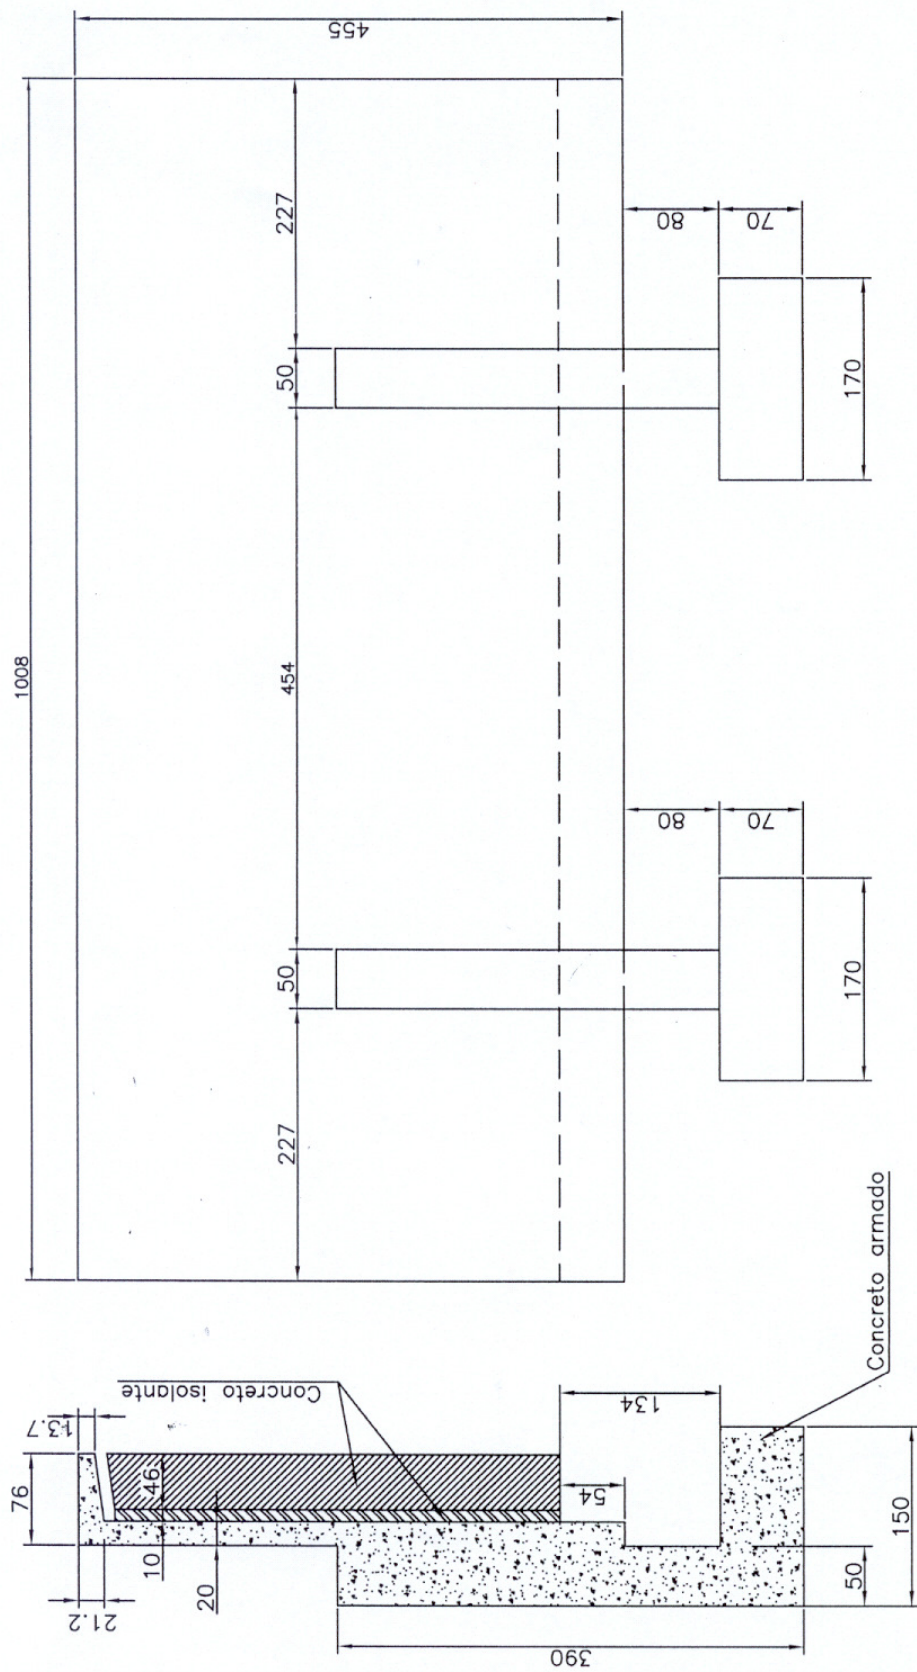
Projeto da geometria do reforço tipo 1
